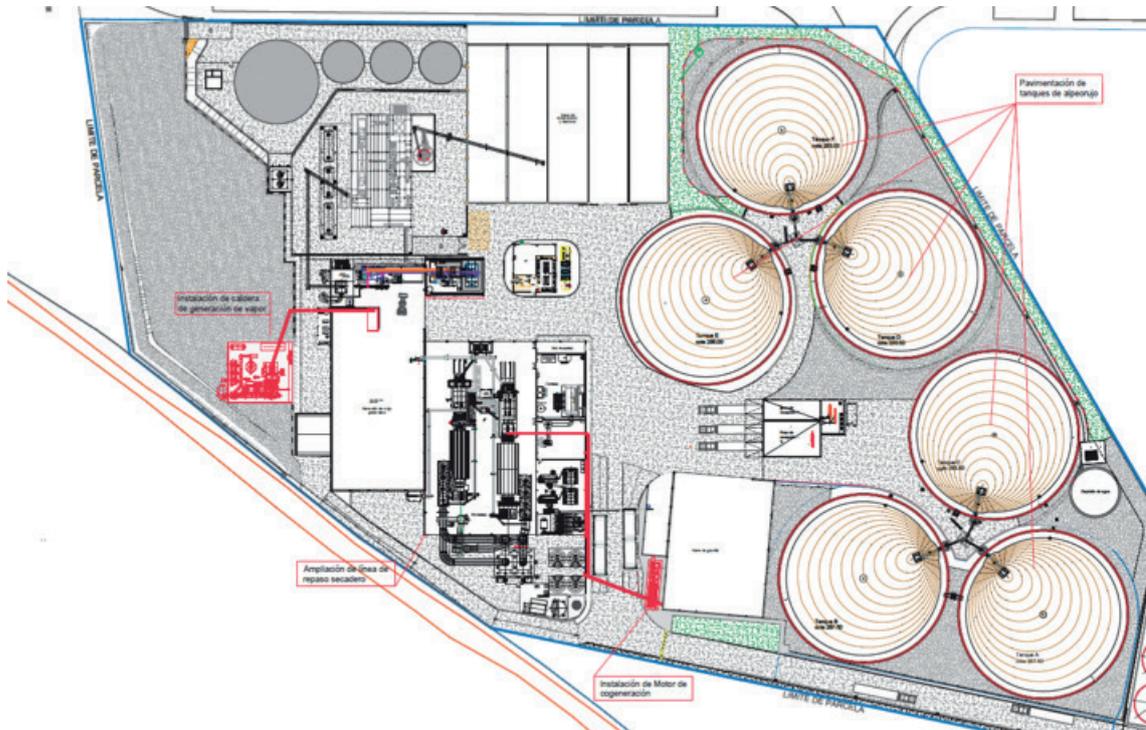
Plano en planta. Modificaciones proyectadas en la zona de repaso.
